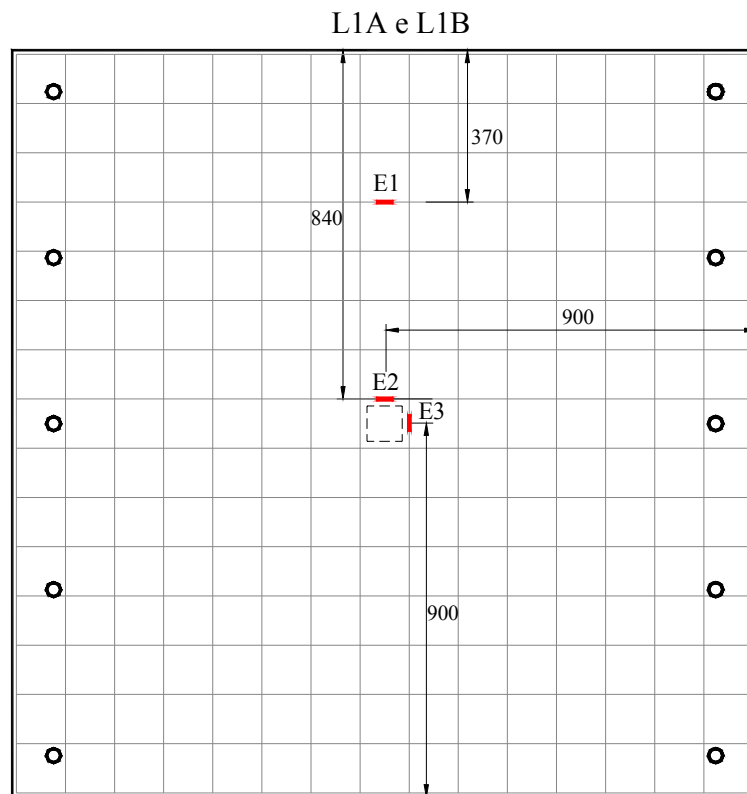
Instalação de extensômetros nas armaduras principal e secundária das lajes L1A e L1B
